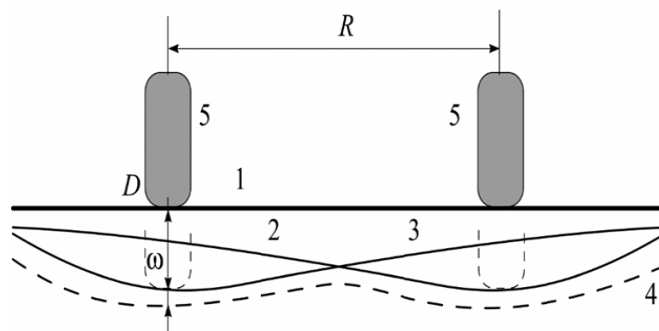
Схема деформирования дорожной конструкции с нежестким анизотропным многослойным асфальтобетонным покрытием при нагружении транспортным средством.
